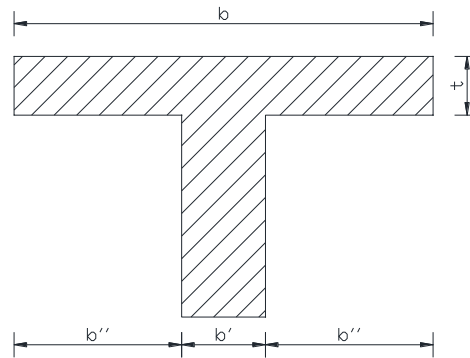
Esquema de dimensiones de viga T aislada.
